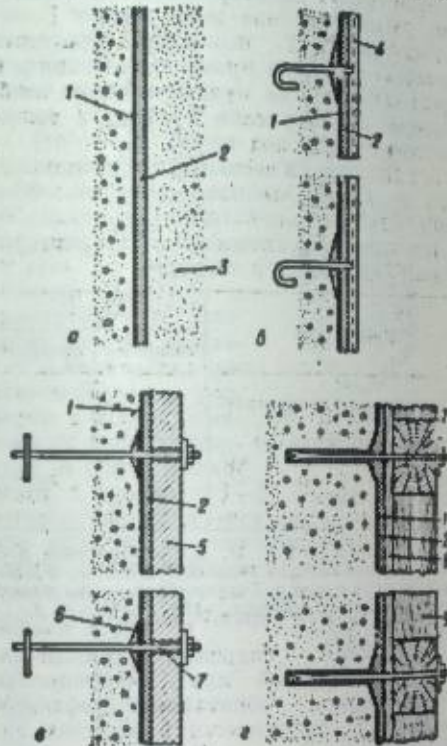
Холодная асфальтовая гидроизоляция с защитными покрытиями: а — присыпка грунтом; б — торкрет-штукатурка по сетке; 1 — железобетонные плиты; 2 — деревянная опалубка; 3 — грунтовка основания; 4 — холодная асфальтовая мастика; 5 — грунтовая дрессинка; 6 — цементный торкрет по стальной сетке; 7 — железобетонные плиты; 8 — защитная сетка; 9 — анкерный болт; 10 — дощатая опалубка; 11 — приемный брус.
